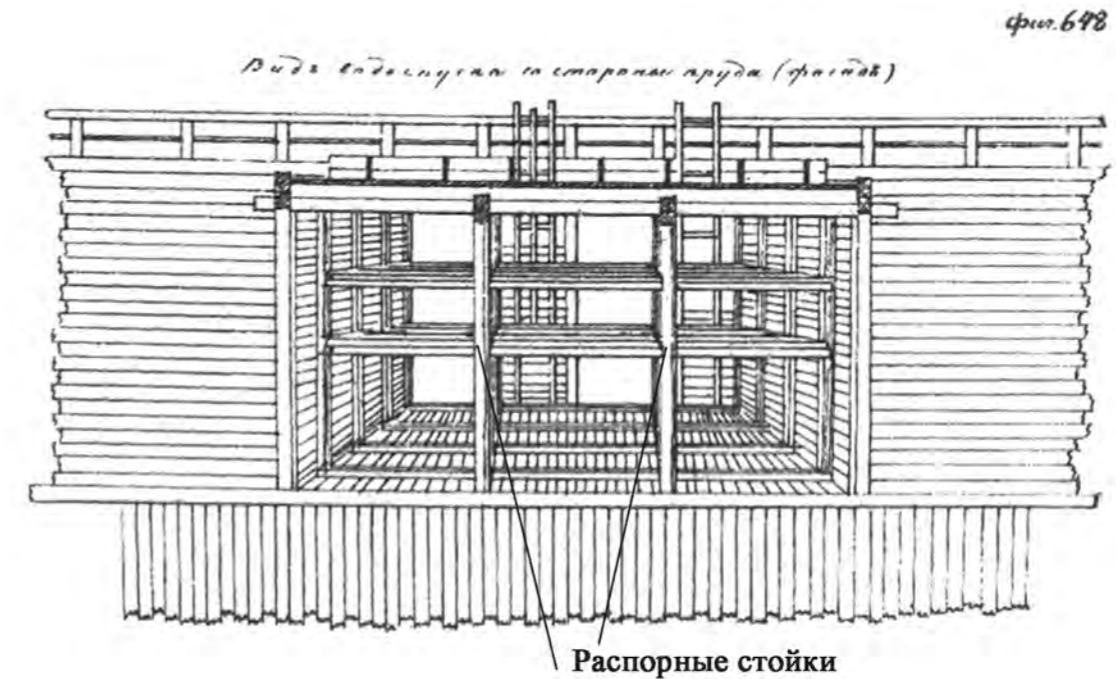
Фасад водоспуска (по Д.Д. Неелову).
